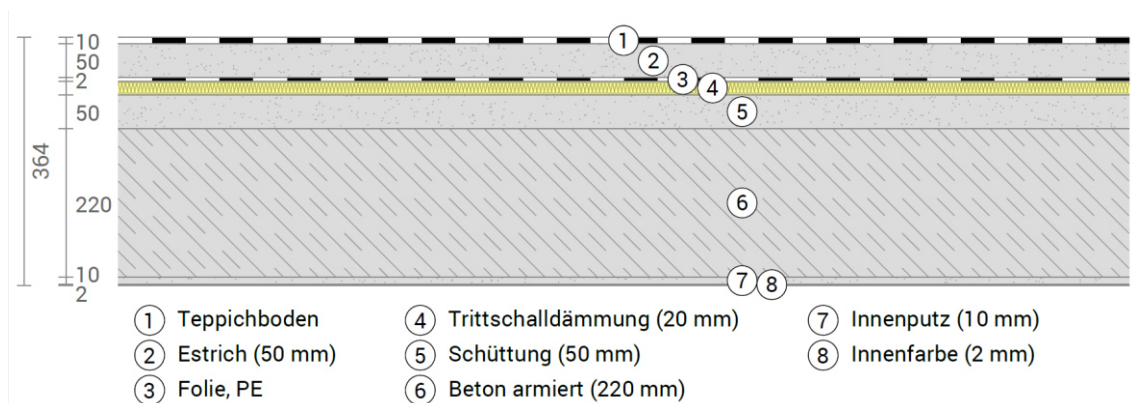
Abgeschätzter Bauteilaufbau der Bestandsgeschossdecke
